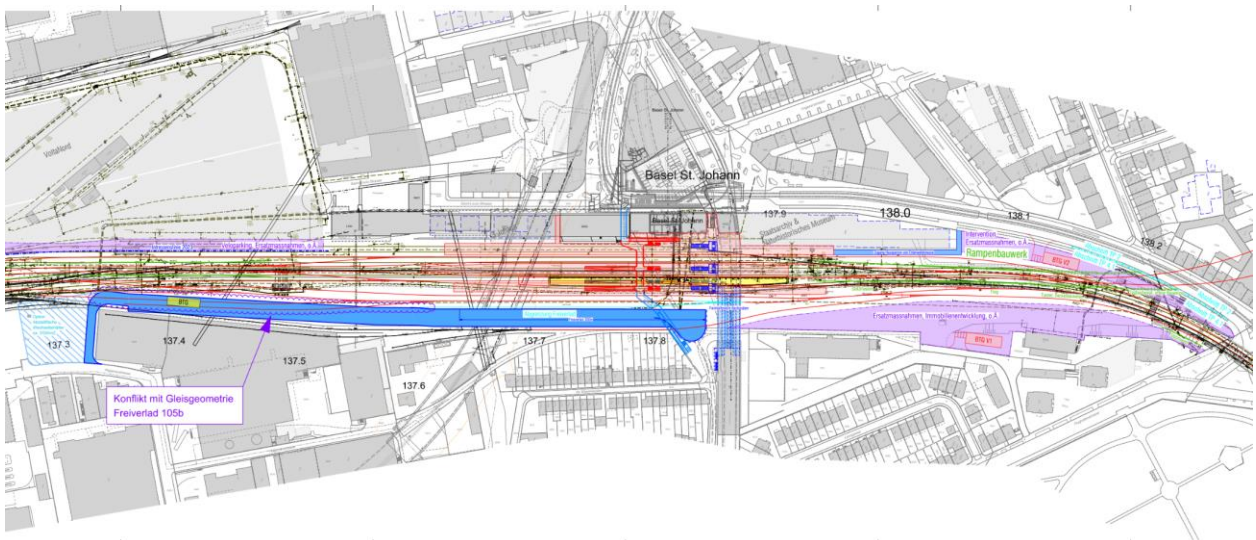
Situationsplan Perimeter Bahnhof St. Johann
